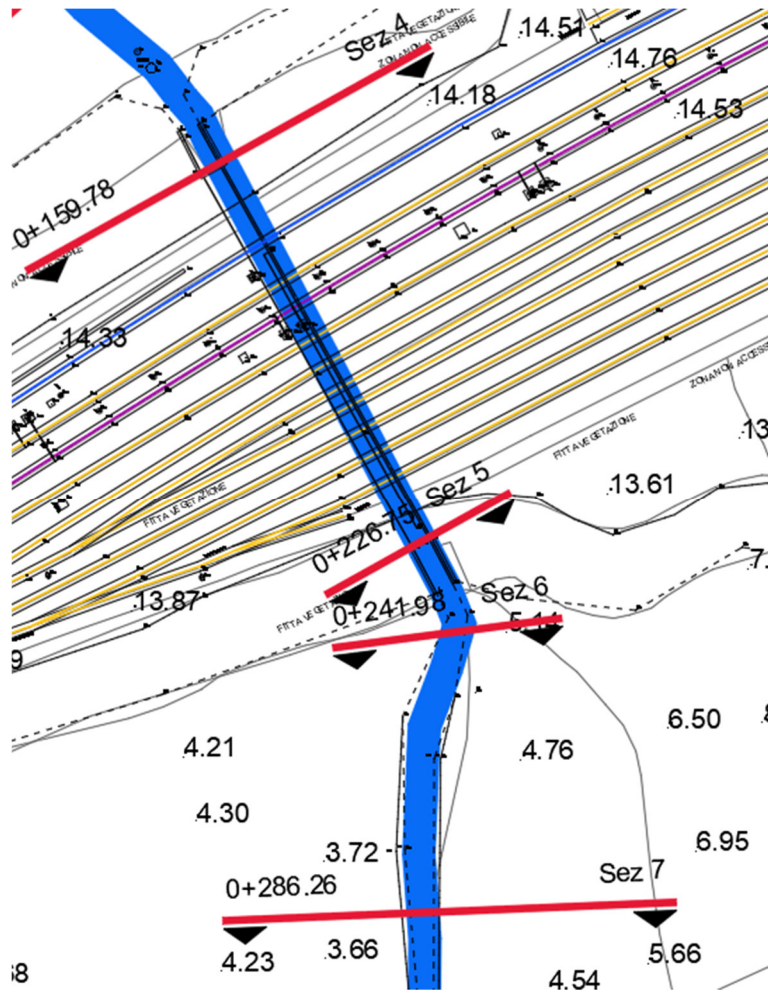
Estratto dalla tavola stato di fatto in corrispondenza dell'intersezione IN02
